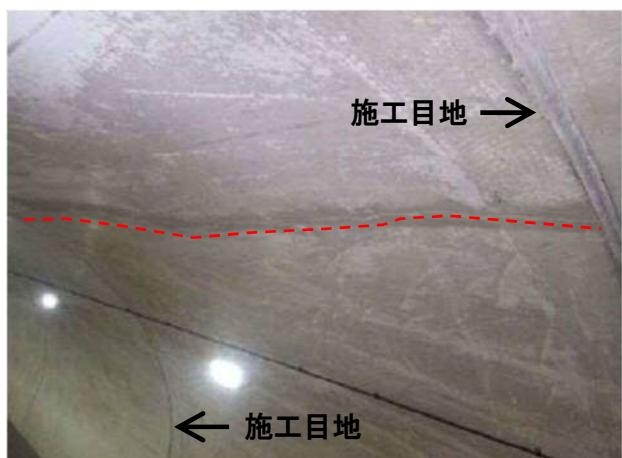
アーチ部の縦断方向ひび割れ
